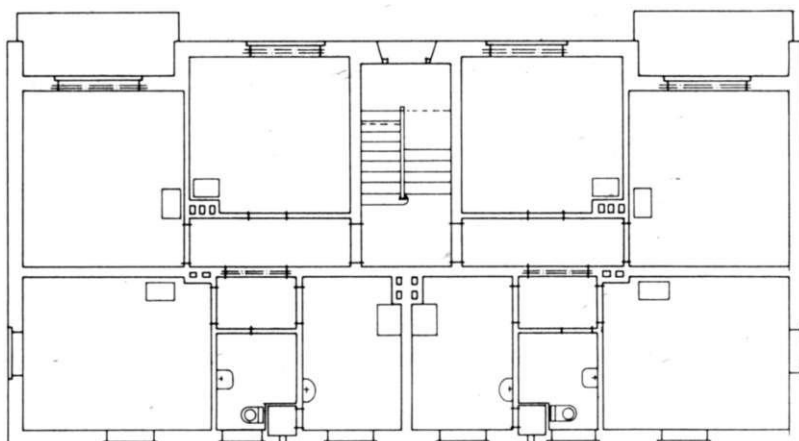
Brunnerstraße 3, Typ I, Haus 1 u. 2, Dachgeschoß
